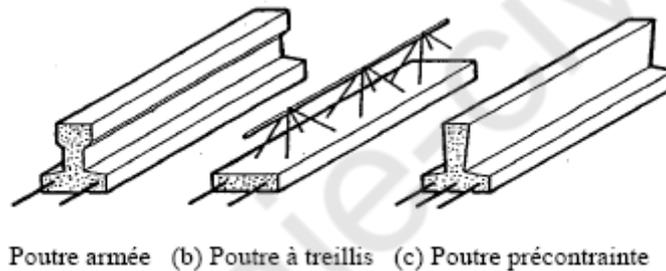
Types de poutres pour planchers poutre entrevous
